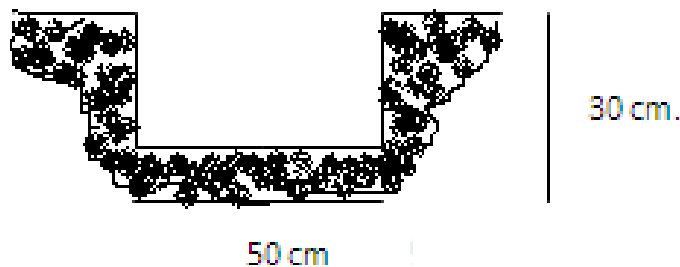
Canal descubierto a ser reconstruido (Alvarez R. 2009)
